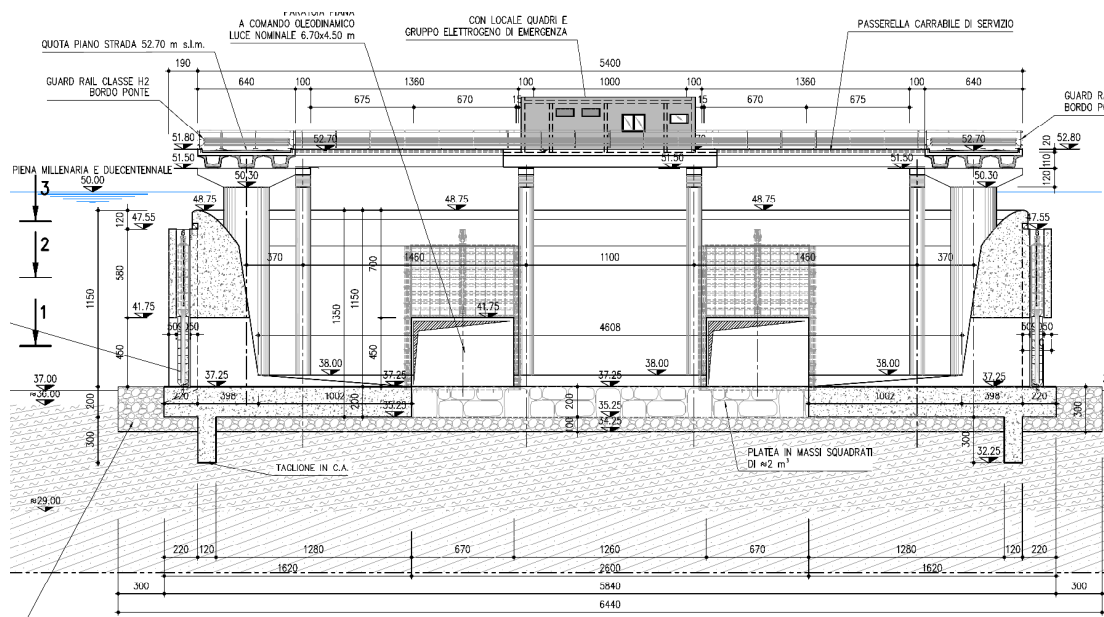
Adeguamento manufatto di regolazione – Sezione tratti longitudinali e vista tratto trasversale
